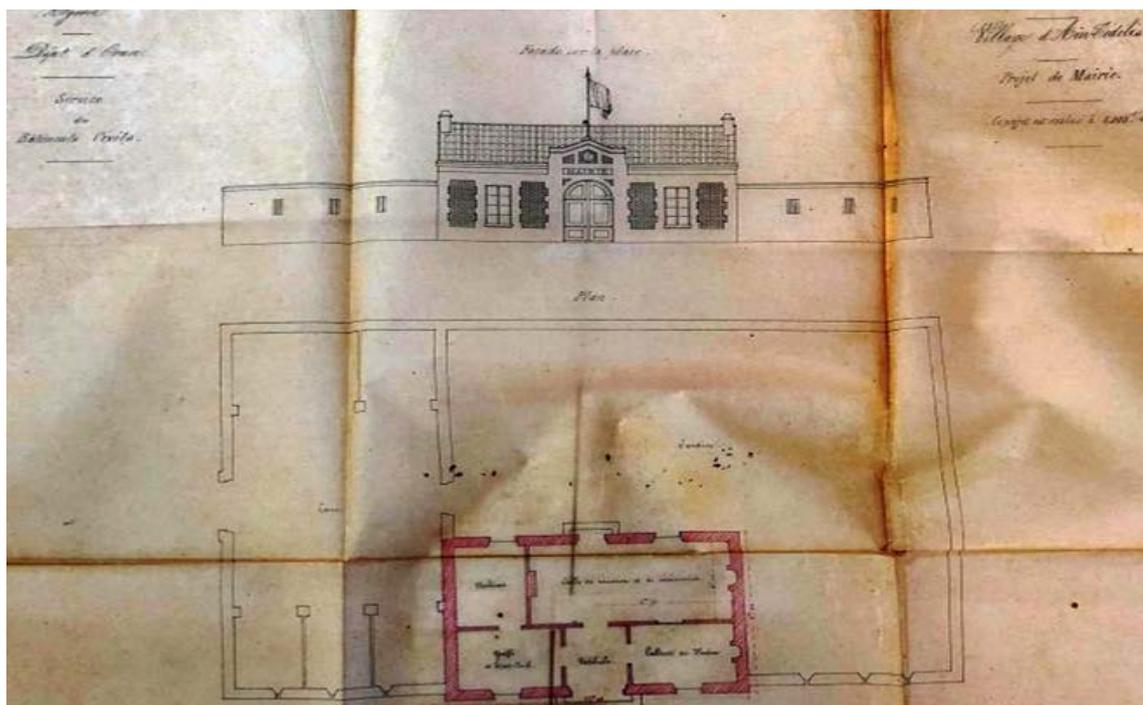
Plan du RDC, façade principale de la mairie d'Aïn Tedelès [85].
